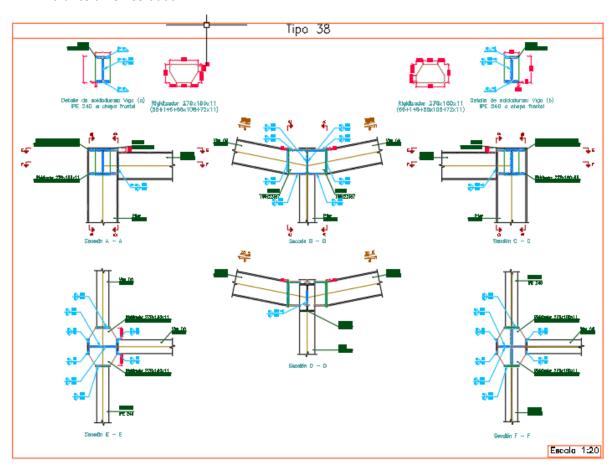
Detalle de unión soldada de jácena, viga central y pilar
